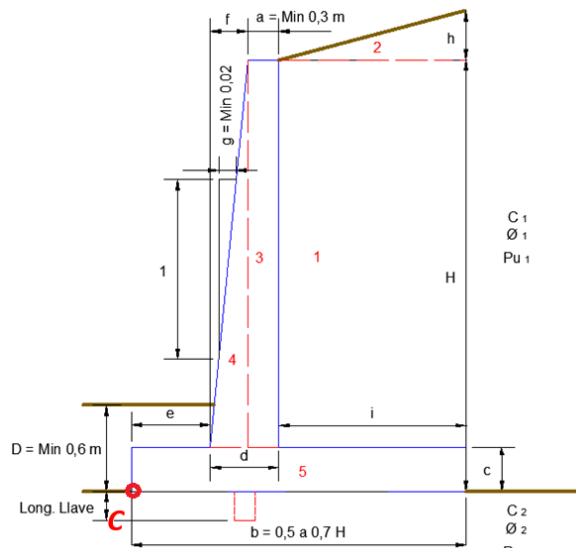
Esquema predimensionamiento muro de voladizo en concreto reforzado
